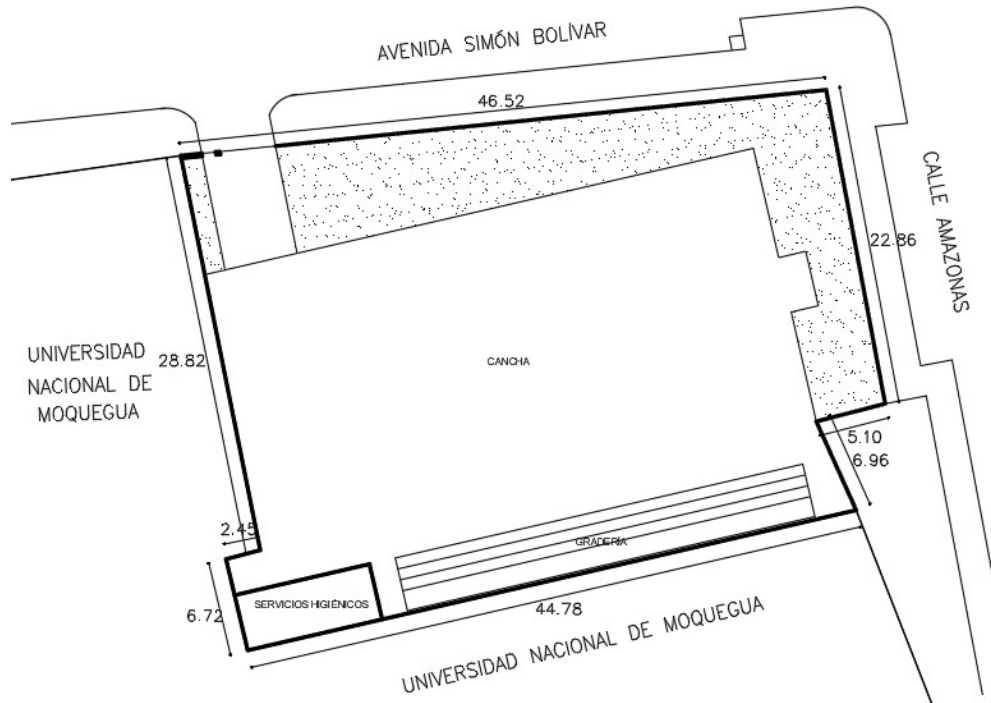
Plano de planta del inmueble. Nota: Elaboración propia.
